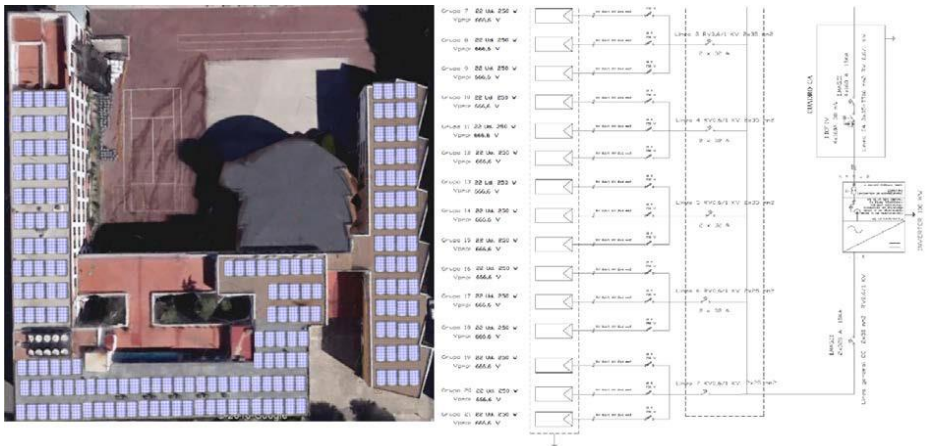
Detalle del proyecto de ingeniería desarrollado por los alumnos de la asignatura de Proyectos de la Universidad.
